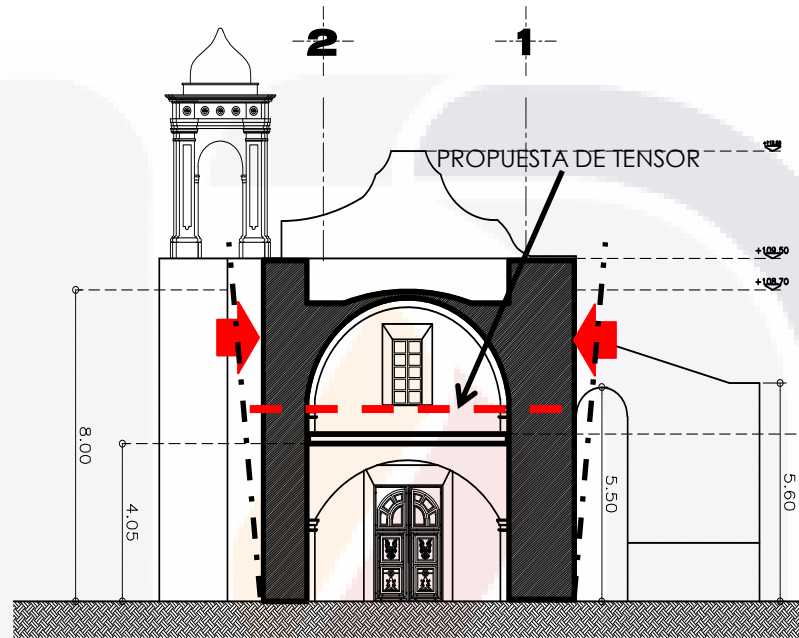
Esquema de propuesta en alzado para la colocación de tensores para contrarrestar la fuerza horizontal que ejerce el sistema de bóvedas sobre el muro.
